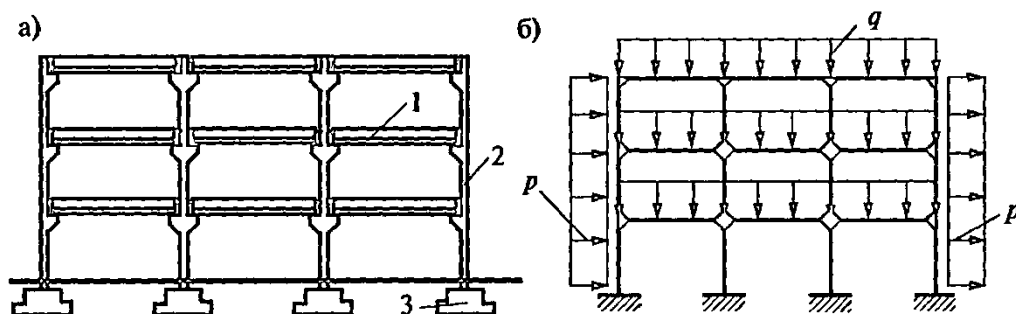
Рамная схема каркаса: а) конструктивная схема; б) расчетная схема; 1 — неразрезанный ригель; 2 — колонна; 3 — фундамент
